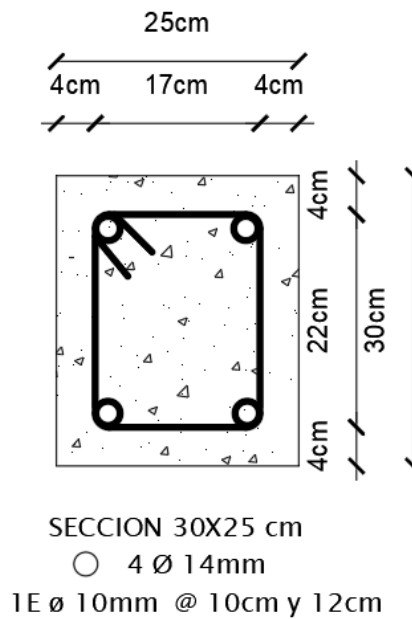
Armado de la viga de hormigón, estructura de bambú.
